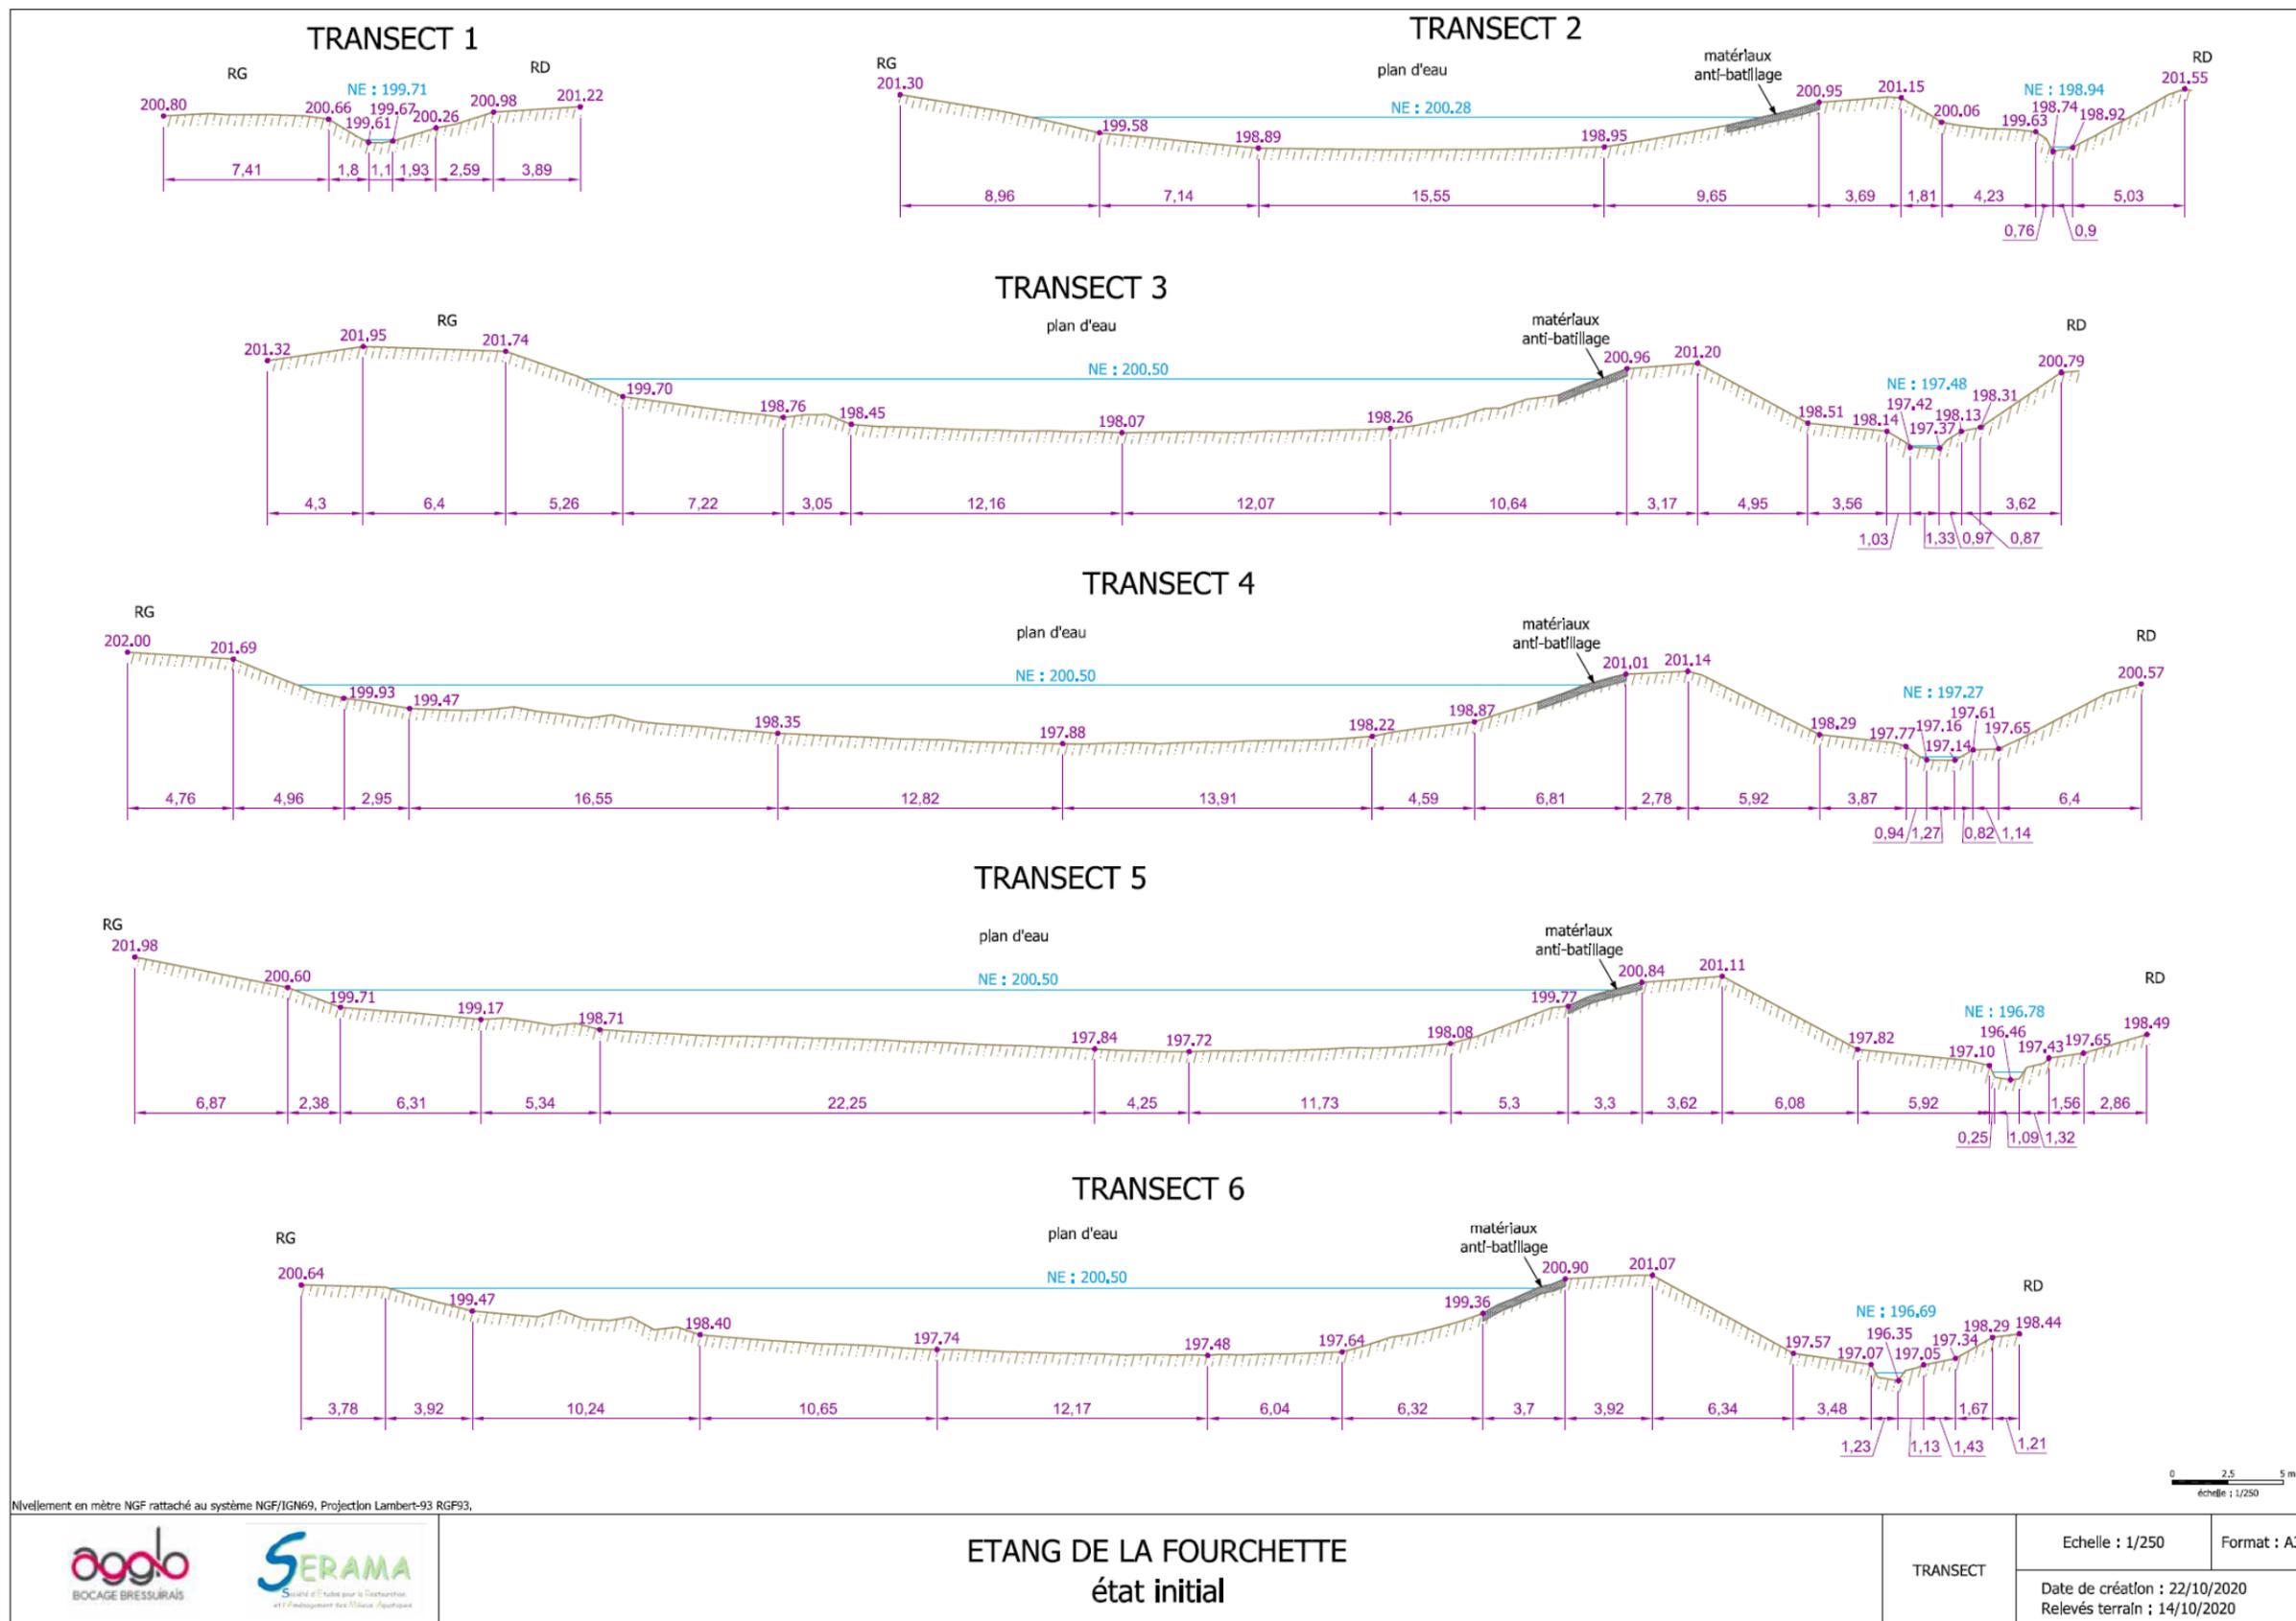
Profils en travers du lit du ruisseau et du plan d'eau
